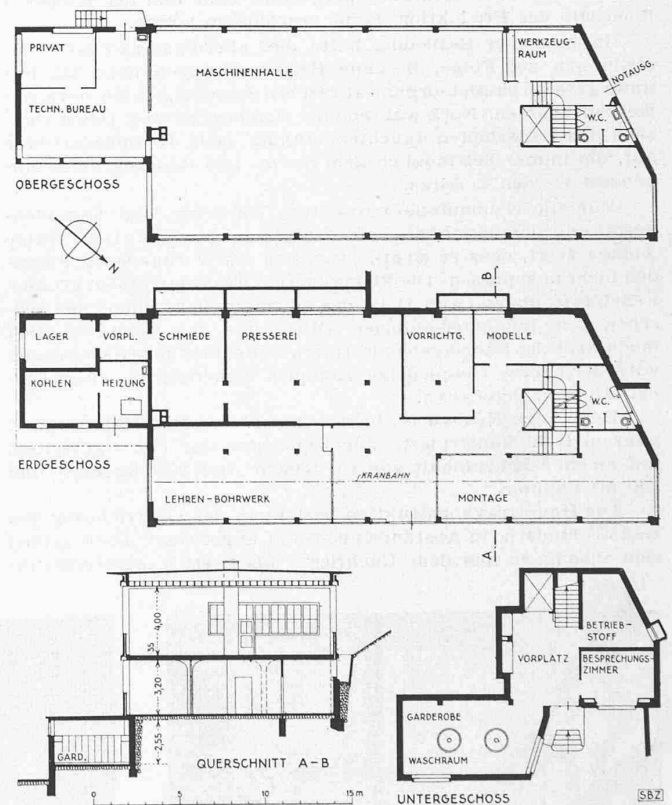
Grundrisse und Schnitt 1: 400
